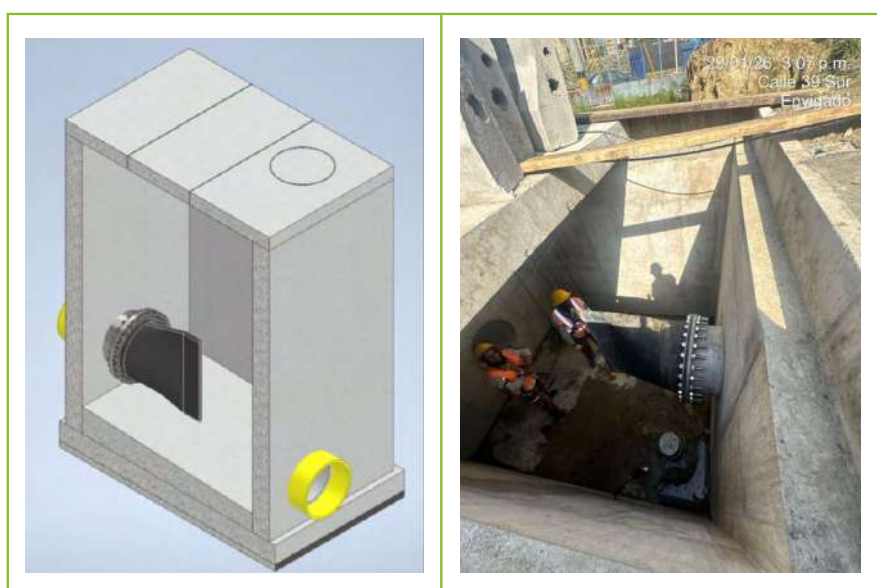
Construcción de caja en concreto reforzado e instalación de válvula pico de pato 750 mm (30"), Desvío Interceptor.
